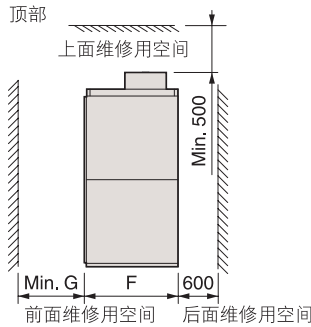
10kV : 2600, 3050, 3500, 3700, 4000, 4600, 5300kVA
